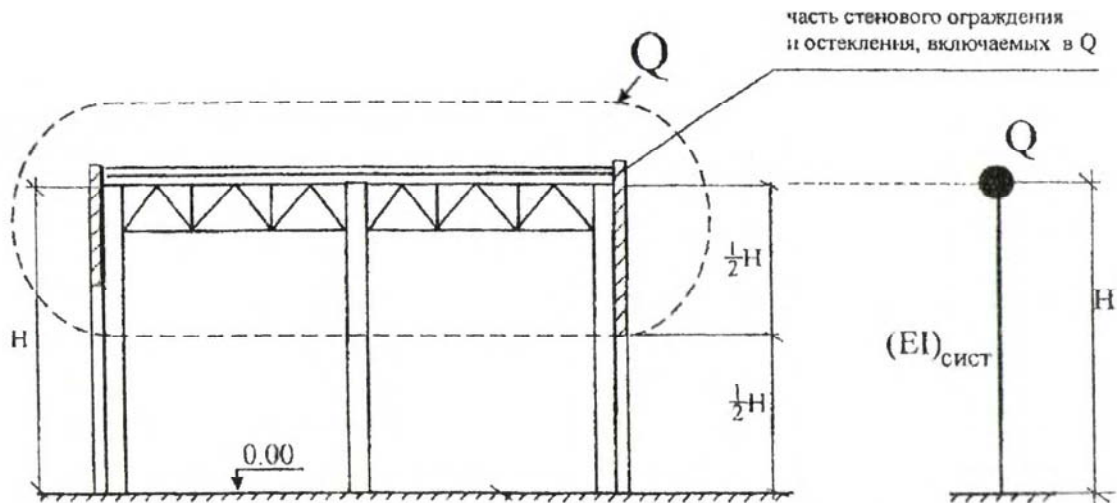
Формирование динамической расчетной схемы при жестком сопряжении стропильной конструкции с колоннами
